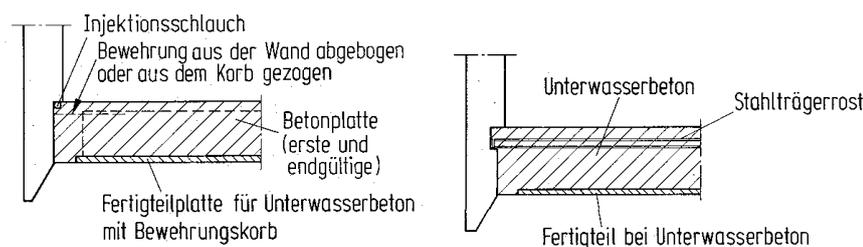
Einlagige Betonplatte – Alternative Ausführungsvarianten [1]
